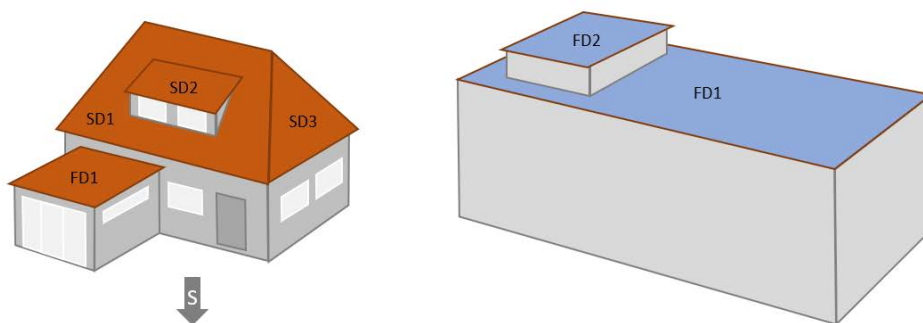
Gebäude mit Walmdach und Anbau mit südlich ausgerichteten Einzeldachflächen Steildach SD1, SD2 und SD3 und Flachdach FD1 (links) sowie Gebäude mit Flachdach und zwei Einzeldachflächen FD1, FD2 (rechts)
